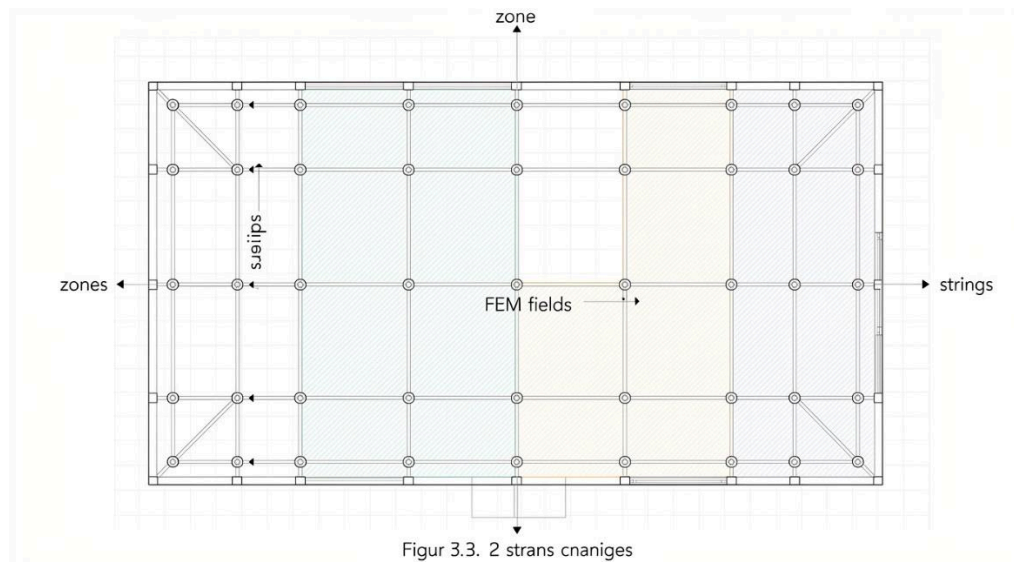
Схематичне розташування полів ФЕМ на покрівлі будівлі
